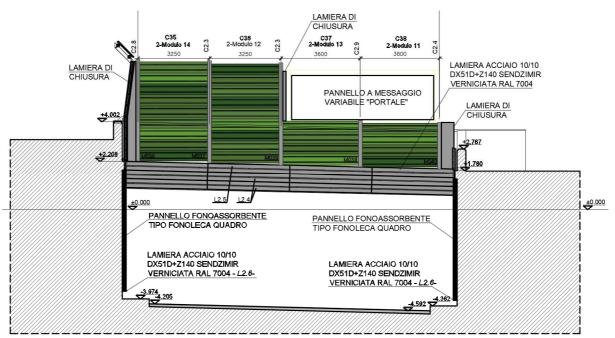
Prospetto della barriera dell'ambito 2 - testata galleria
